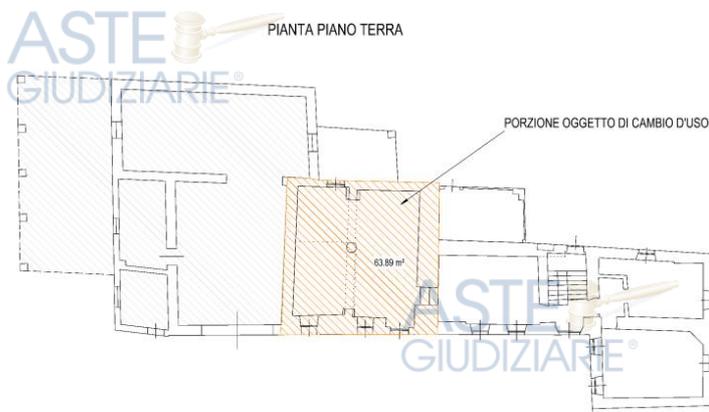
Planimetria di rilievo con evidenziazione del locale oggetto di cambio d'uso
